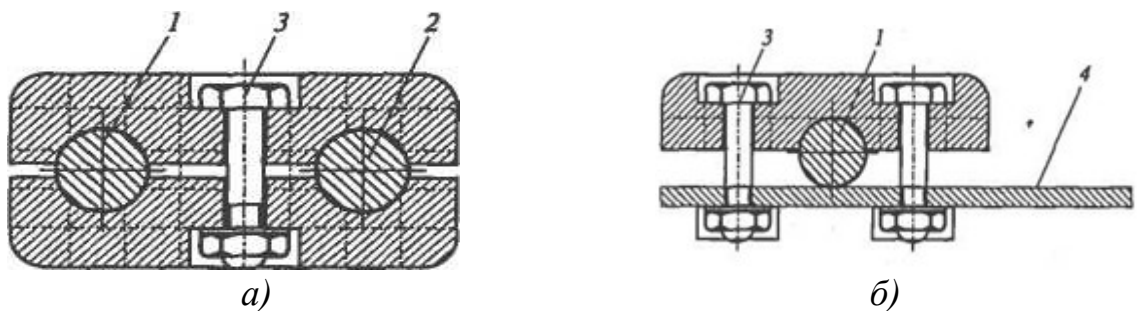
Примеры выполнения соединений между стержнем арматуры и проводом:
